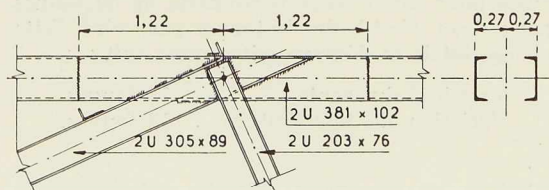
Détail d'un nœud de la membrure supérieure d'une maîtresse-poutre.
